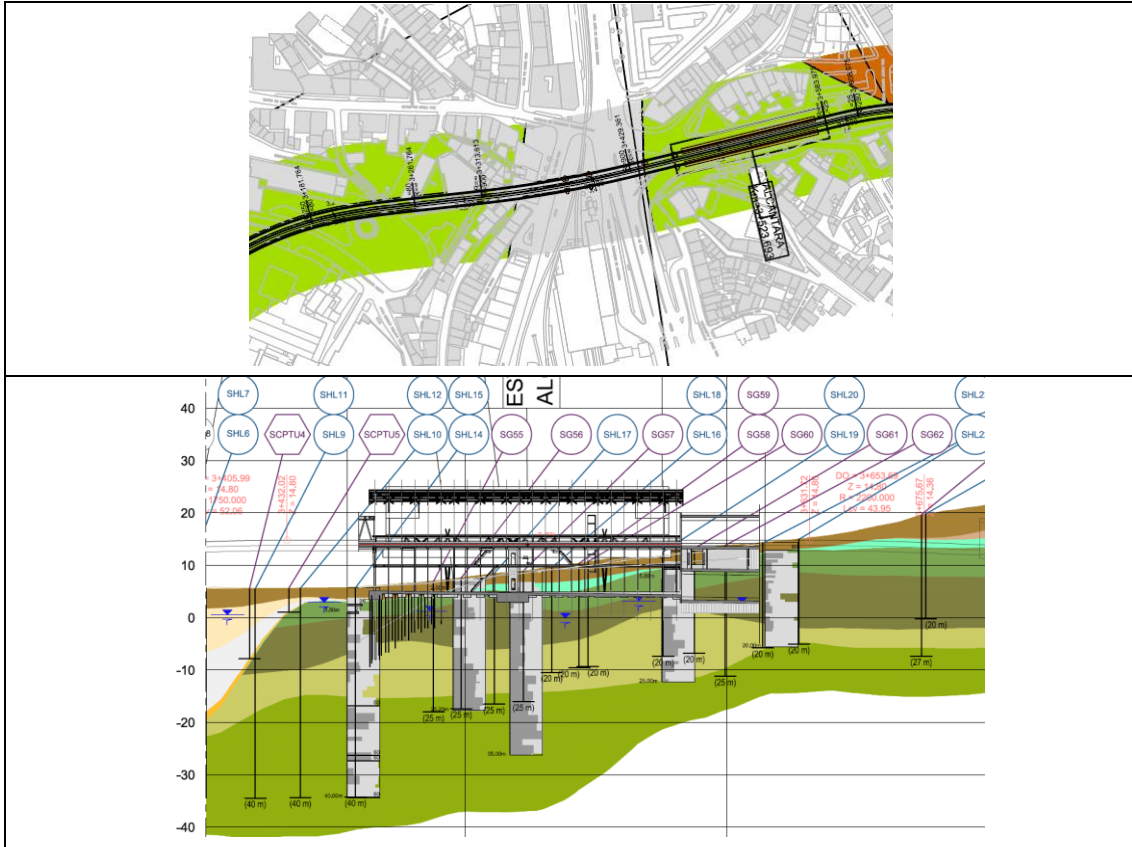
Planta e perfil longitudinal – Geologia / Geotecnia
